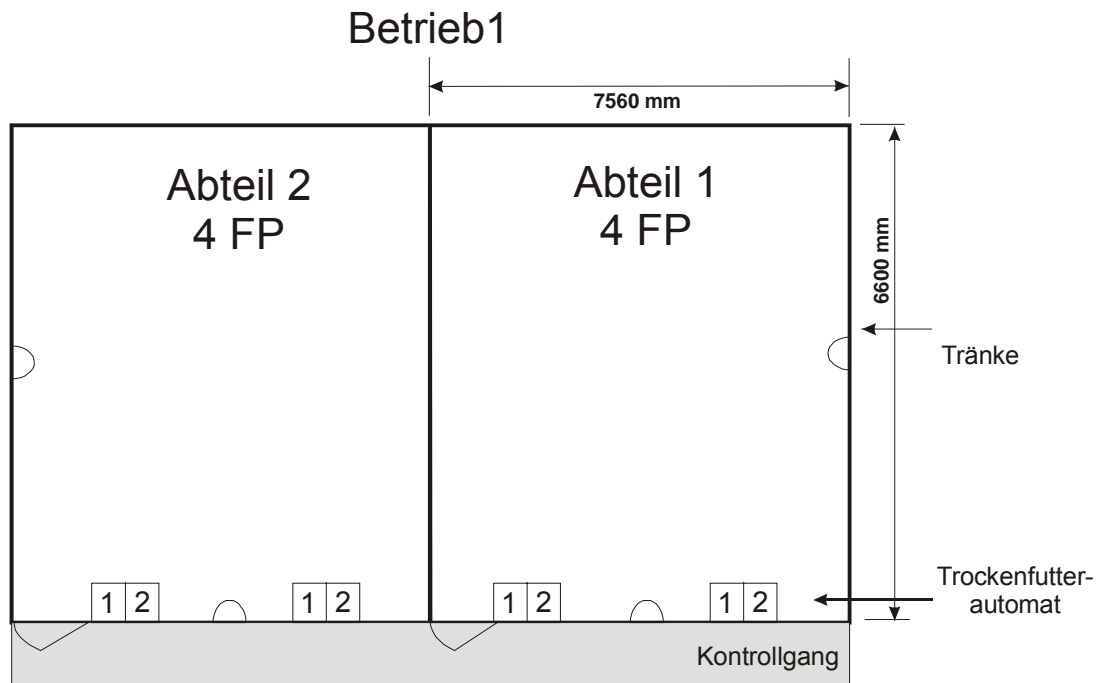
Grundriss der Versuchsbuchten in Betrieb 1
